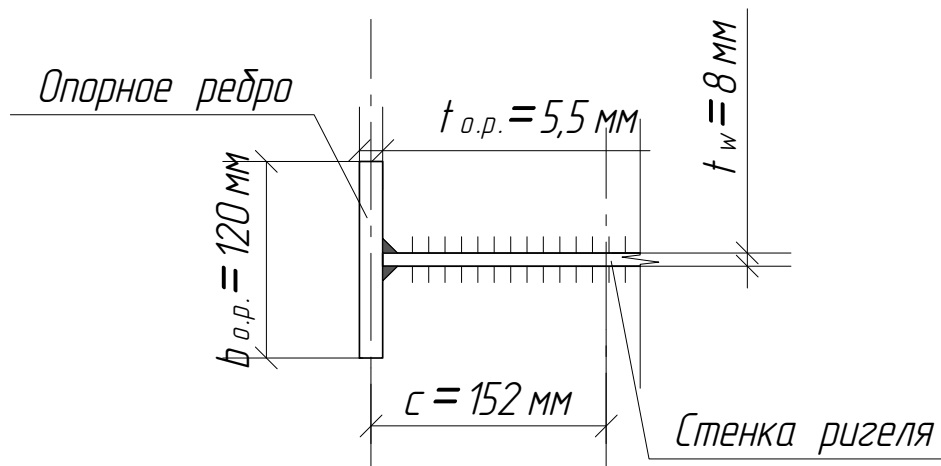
Схема сопряжения опорного ребра ригеля со стенкой.
